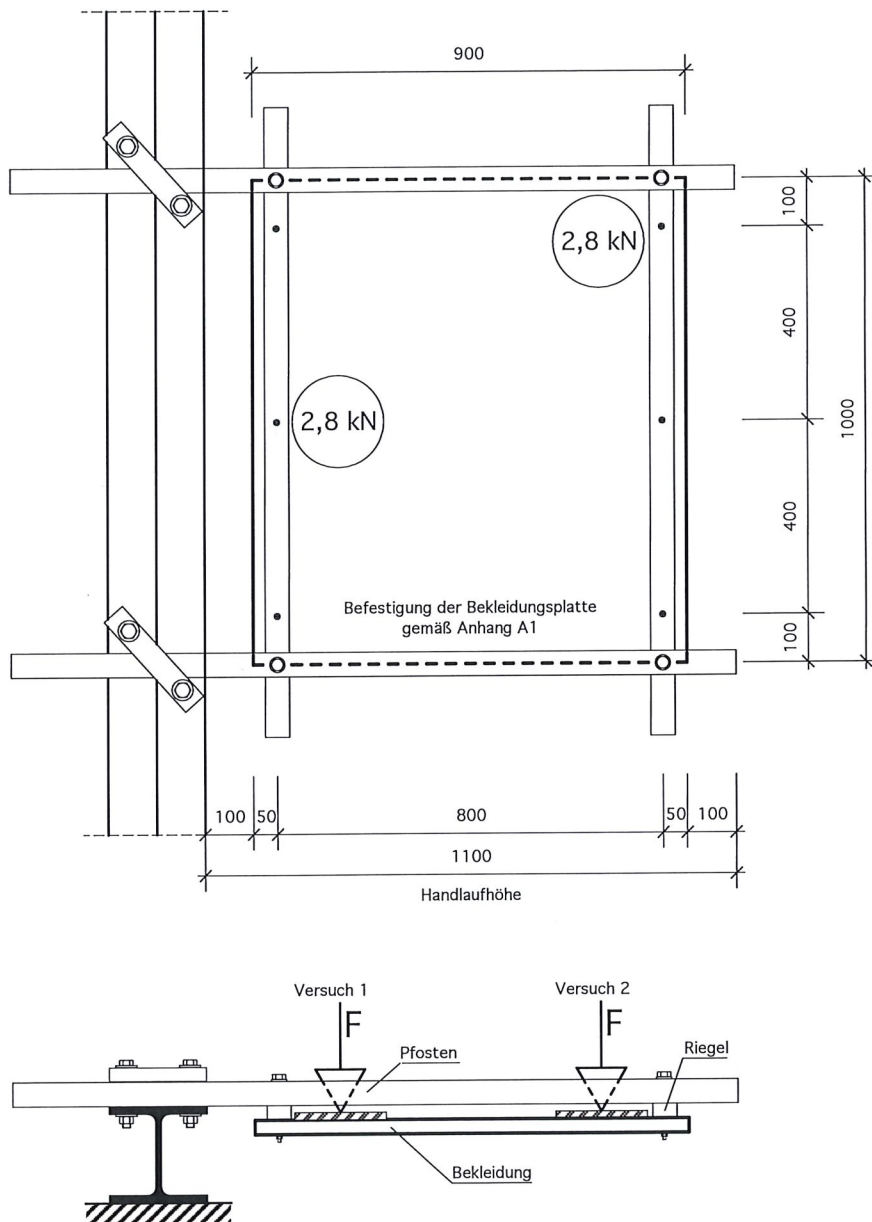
Skizze zum Versuchsaufbau für die Prüfung der Befestigungselemente, Handlaufhöhe 1100 mm – „JD Basic COMPACT“, d = 8 mm
